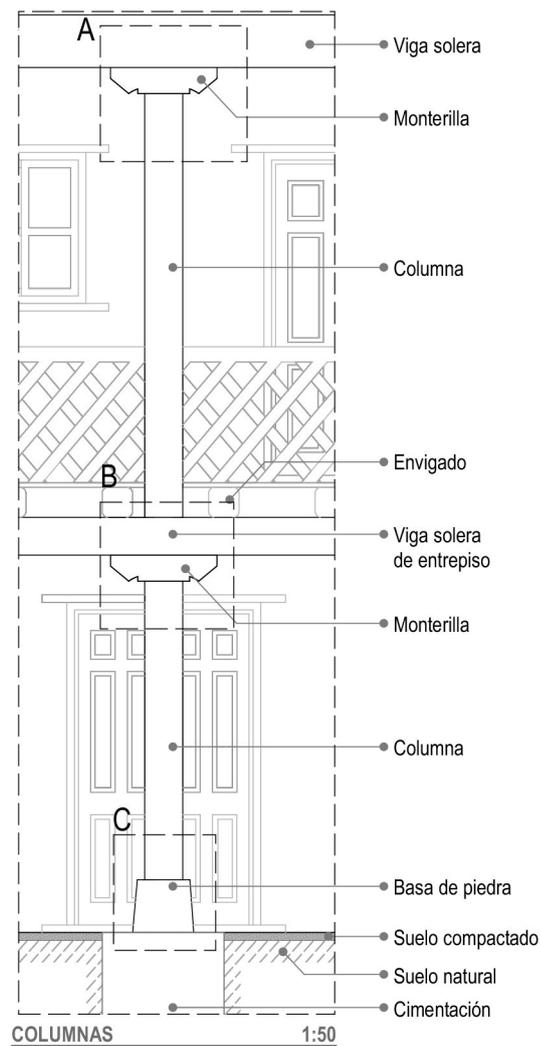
Esquema del sistema de columnas C 102
